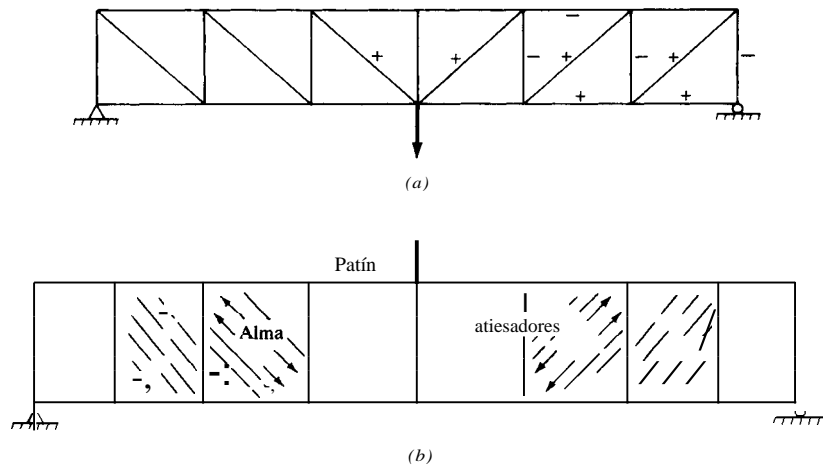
Analogía entre la trabe armada y la armadura Pratt. (a) Armadura Pratt (—) = miembro a compresión. (b) Viga armada con campo de tensión.
